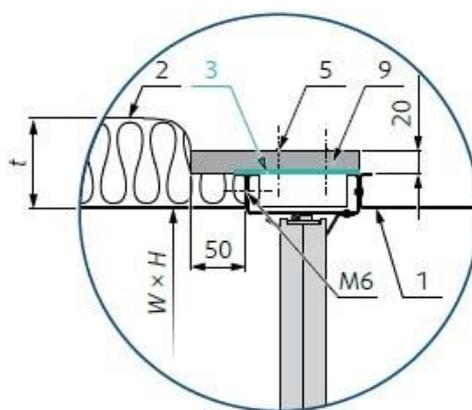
Sezione trasversale del collegamento ad una condotta in metallo isolata con lana minerale e accessorio K1-S-SA2L
